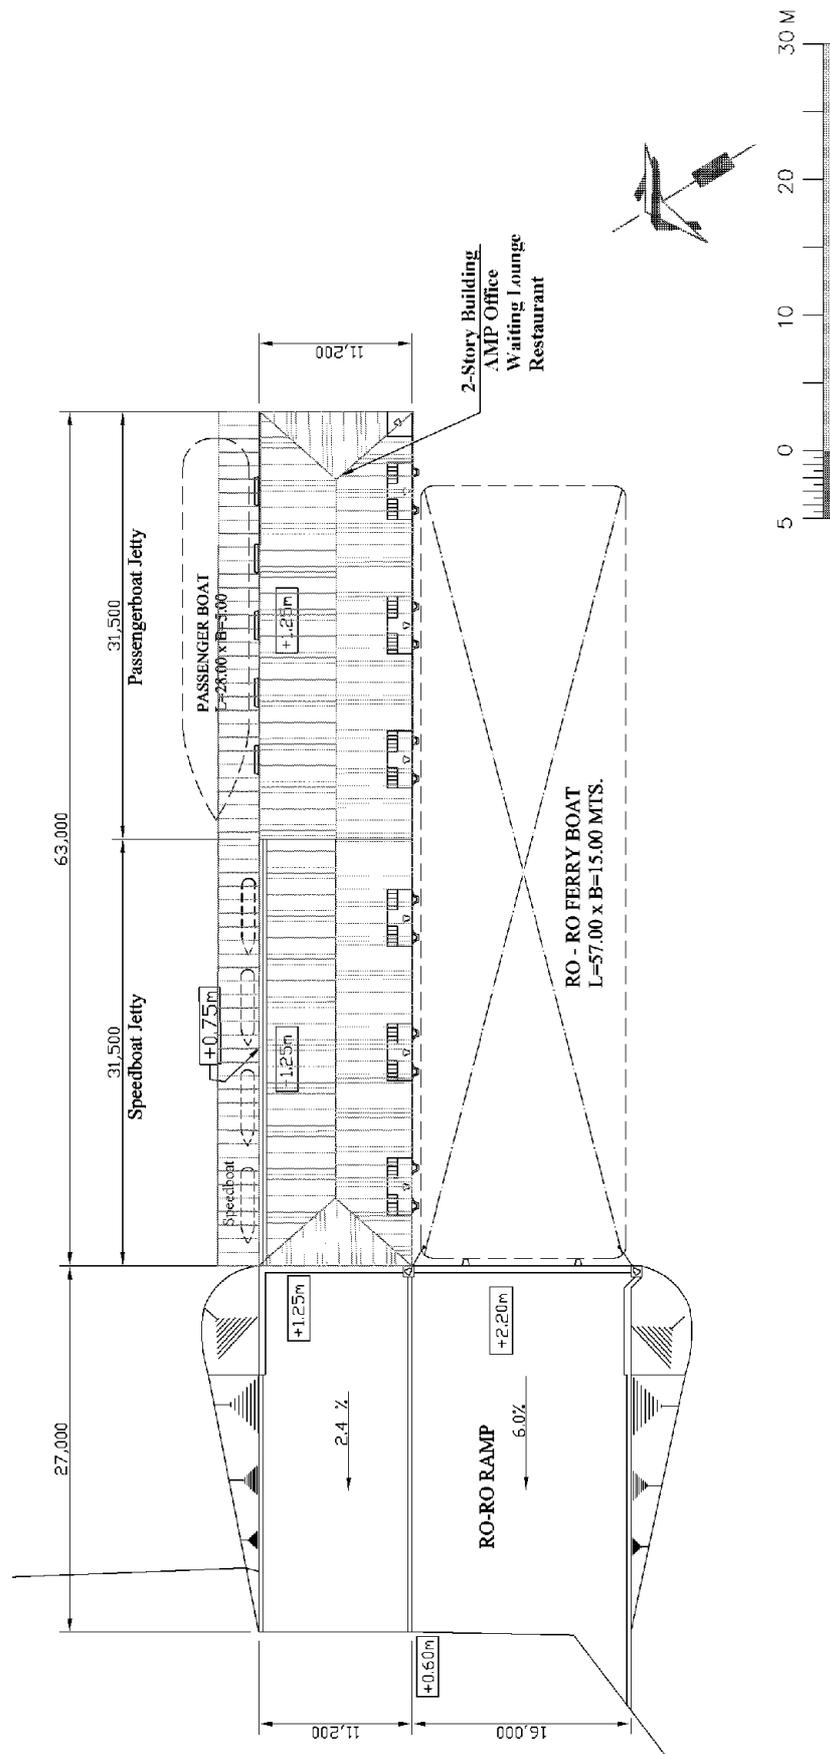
Disposición General del Plan de Instalaciones Marinas
